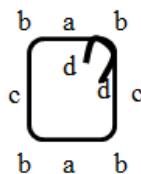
34 Detail pembesian kolom pendek tulangan utama
